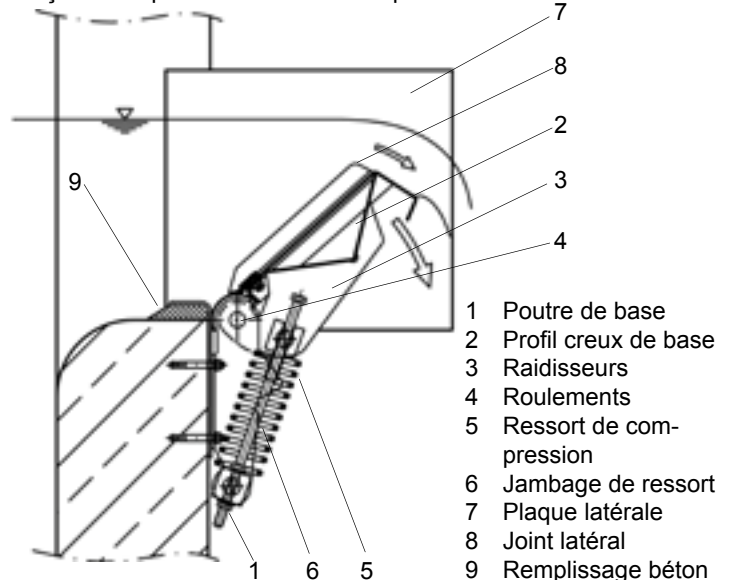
Pièces constitutives du seuil flexible UFT-FluidFlap.
